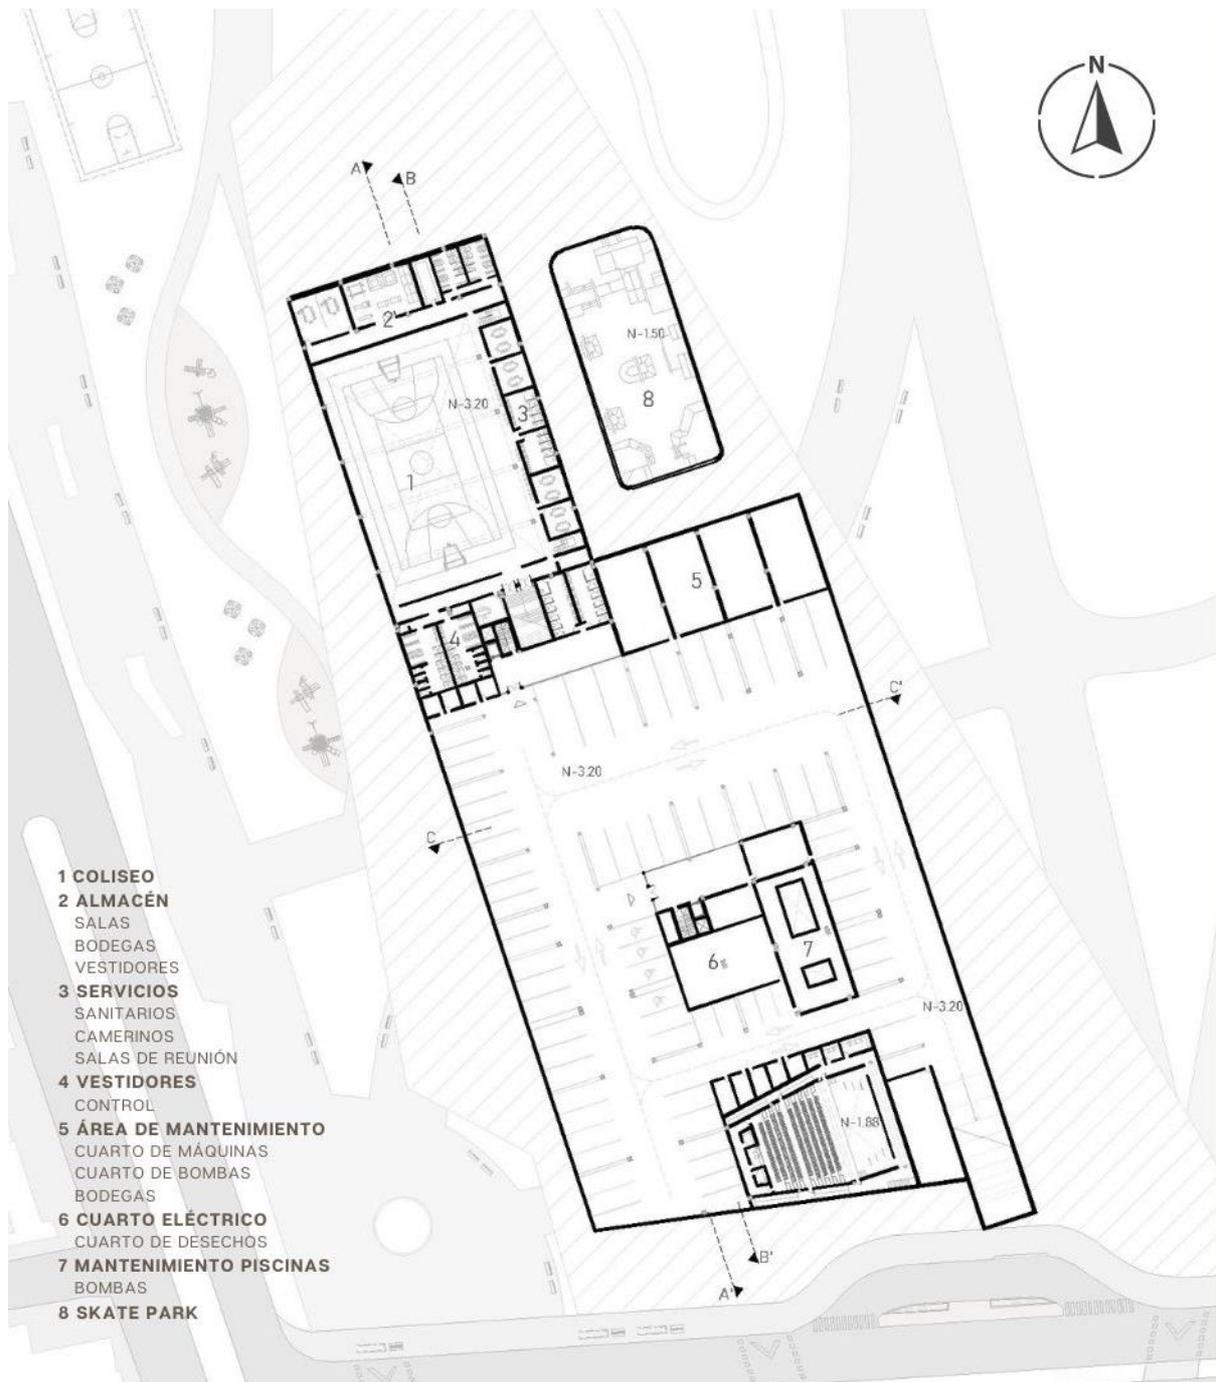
Planta subsuelo Centro Deportivo. Elaboración propia
